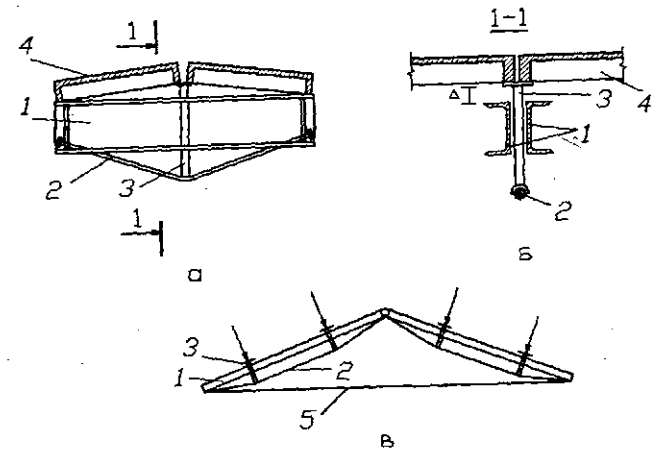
Предварительное напряжение шпренгельных конструкций загрузкой подвижных стоек шпренгеля: а — шпренгельная балка в период загрузки; б — сечение 1—1 балки; в — арочные треугольные фермы с поясами из шпренгельных балок; 1 — балка; 2 — затяжка балок; 3 — подвижная стойка шпренгеля; 4 — настил покрытия; 5 — нижний пояс арочной фермы
